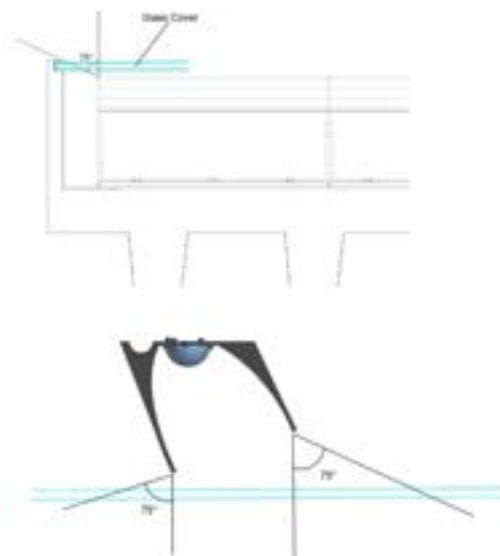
Particolare per la disposizione del vetro rispetto al modulo
